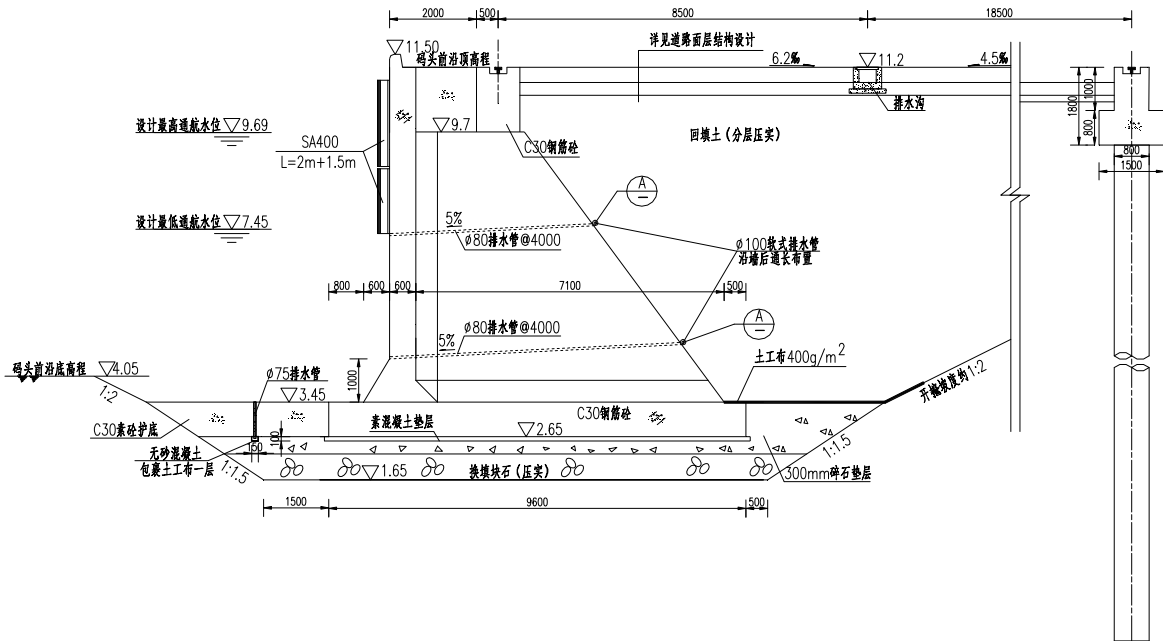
件杂货（棒材）泊位（直线段）断面图
